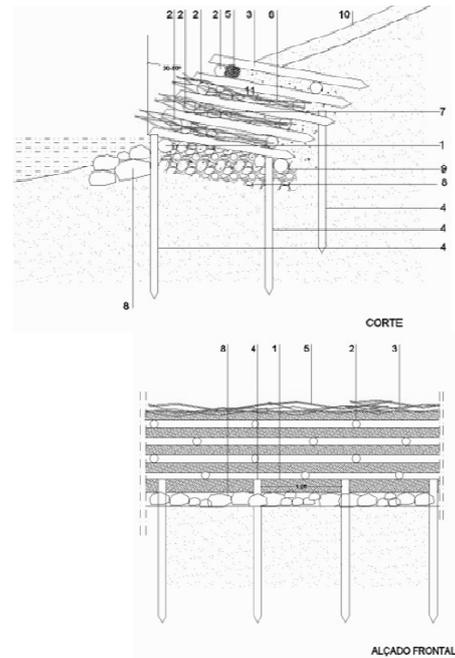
Exemplo de pormenorização de técnicas de contenção mais robustas: Muro de suporte vivo com parede dupla, ou caixa de troncos (“crib wall”, adaptado de Palmeri, 2009).(S/Esc.).
